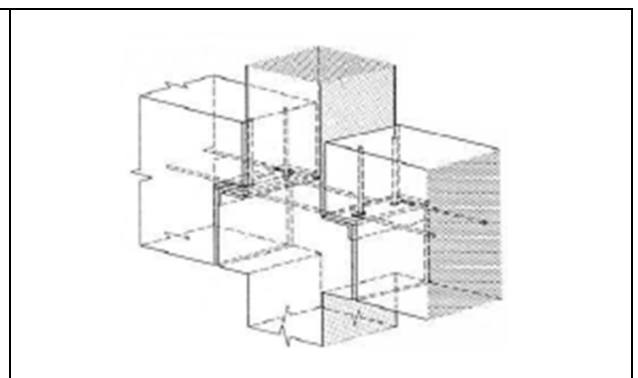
Ligação por consola curta de betão (Stupré, 1981)
